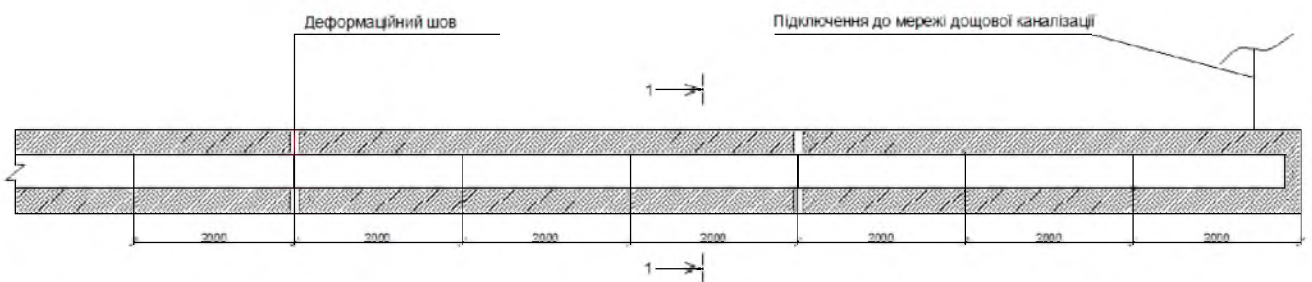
Схема розташування моноблока ACO Monoblock RD300V
